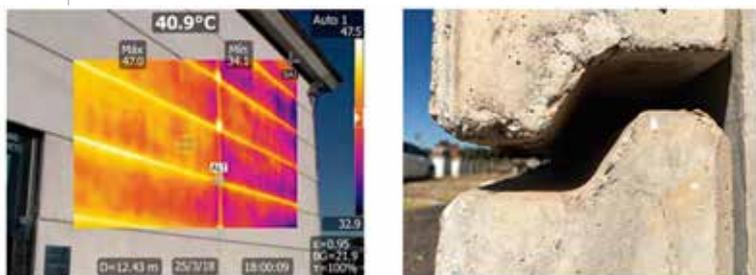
a) Termovisor com medida externa na fachada oeste do laboratório NETPRE; b) Foto da junta horizontal entre painéis de fachada no laboratório NETPre.
